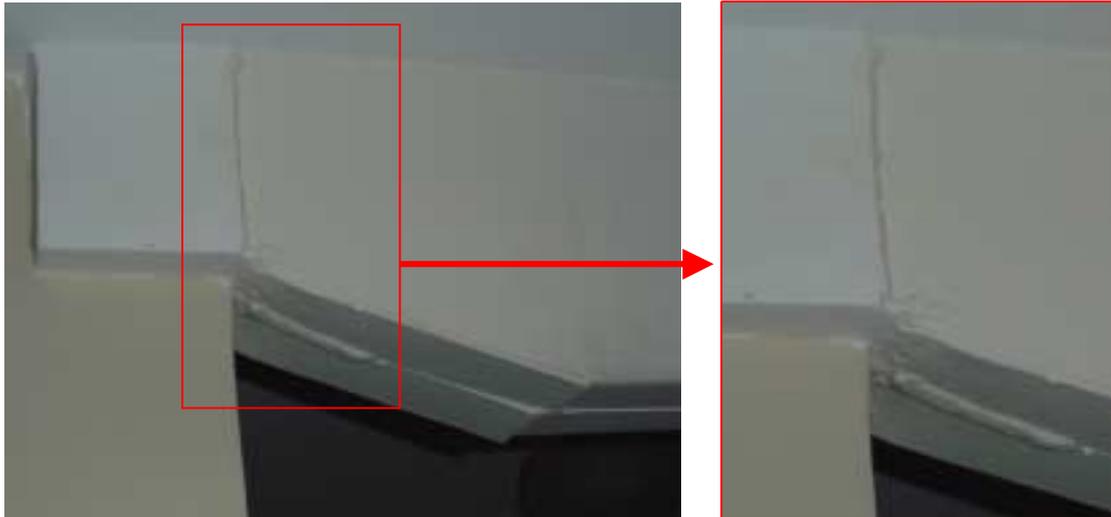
Detalhe de viga aparente nas áreas de circulação da edificação
